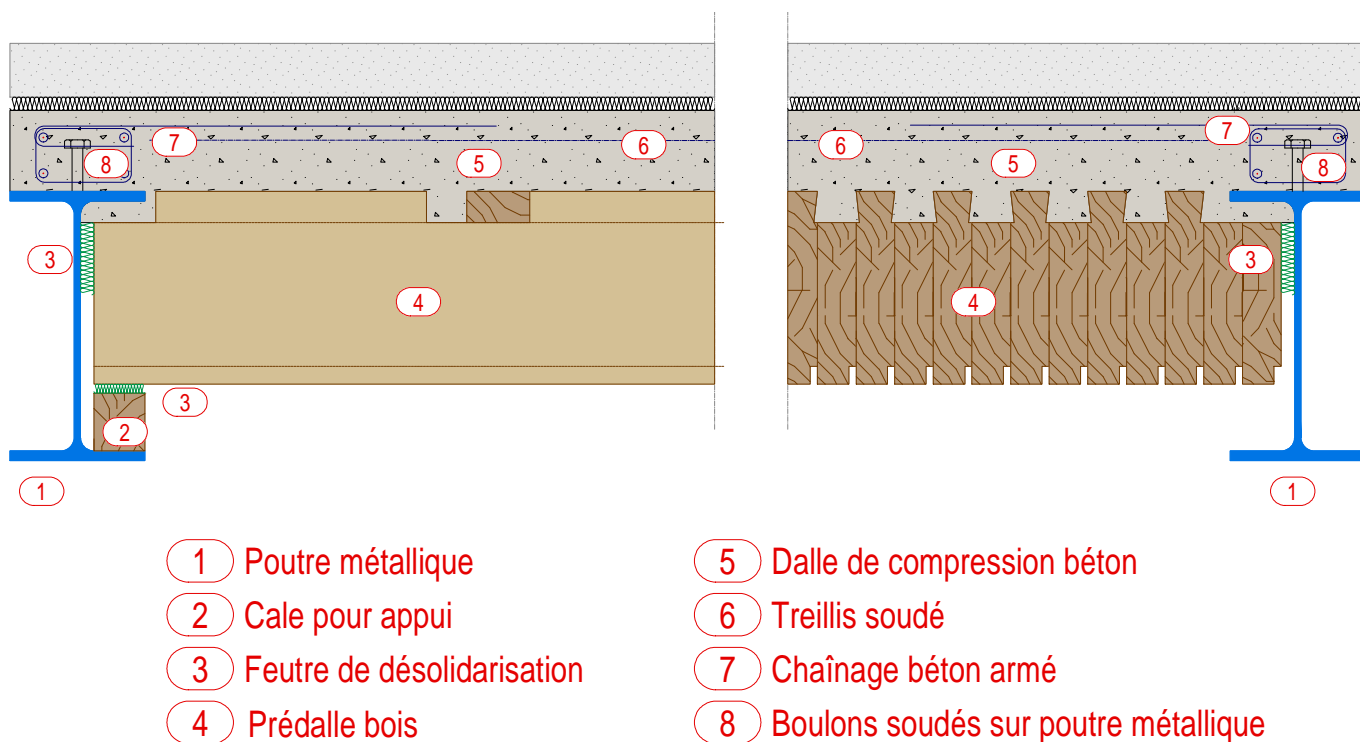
Chaînage du plancher LIGNADAL sur poutre métallique en zone sismique
